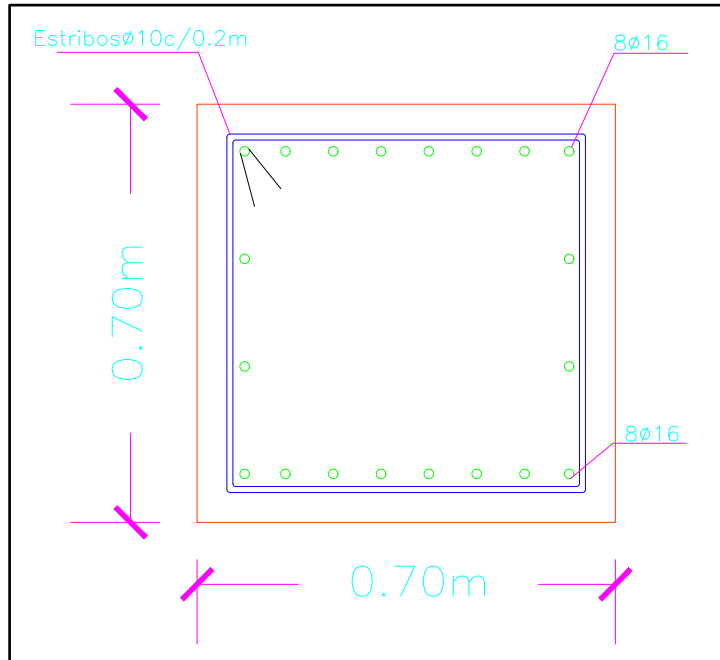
Dimensionamiento de la viga cabezal para el muelle principal. Fuente: Autores
